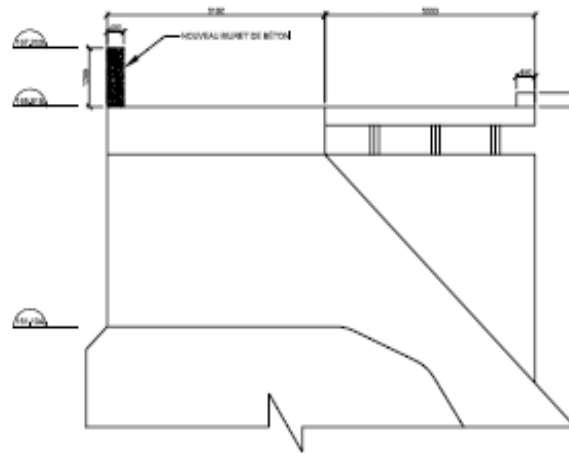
Coupe type du muret de béton pour le rehaussement du barrage Pibrac-Ouest
